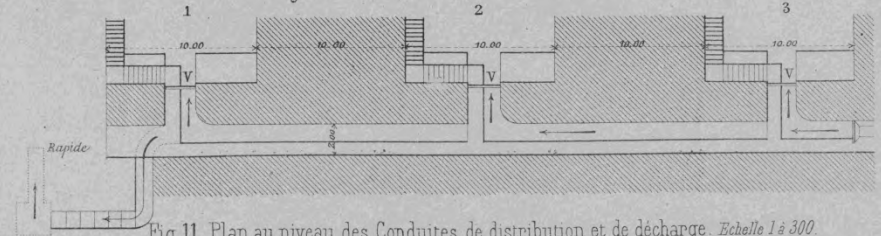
Plan au niveau des Conduites de distribution et de décharge. Echelle 1 à 300.
